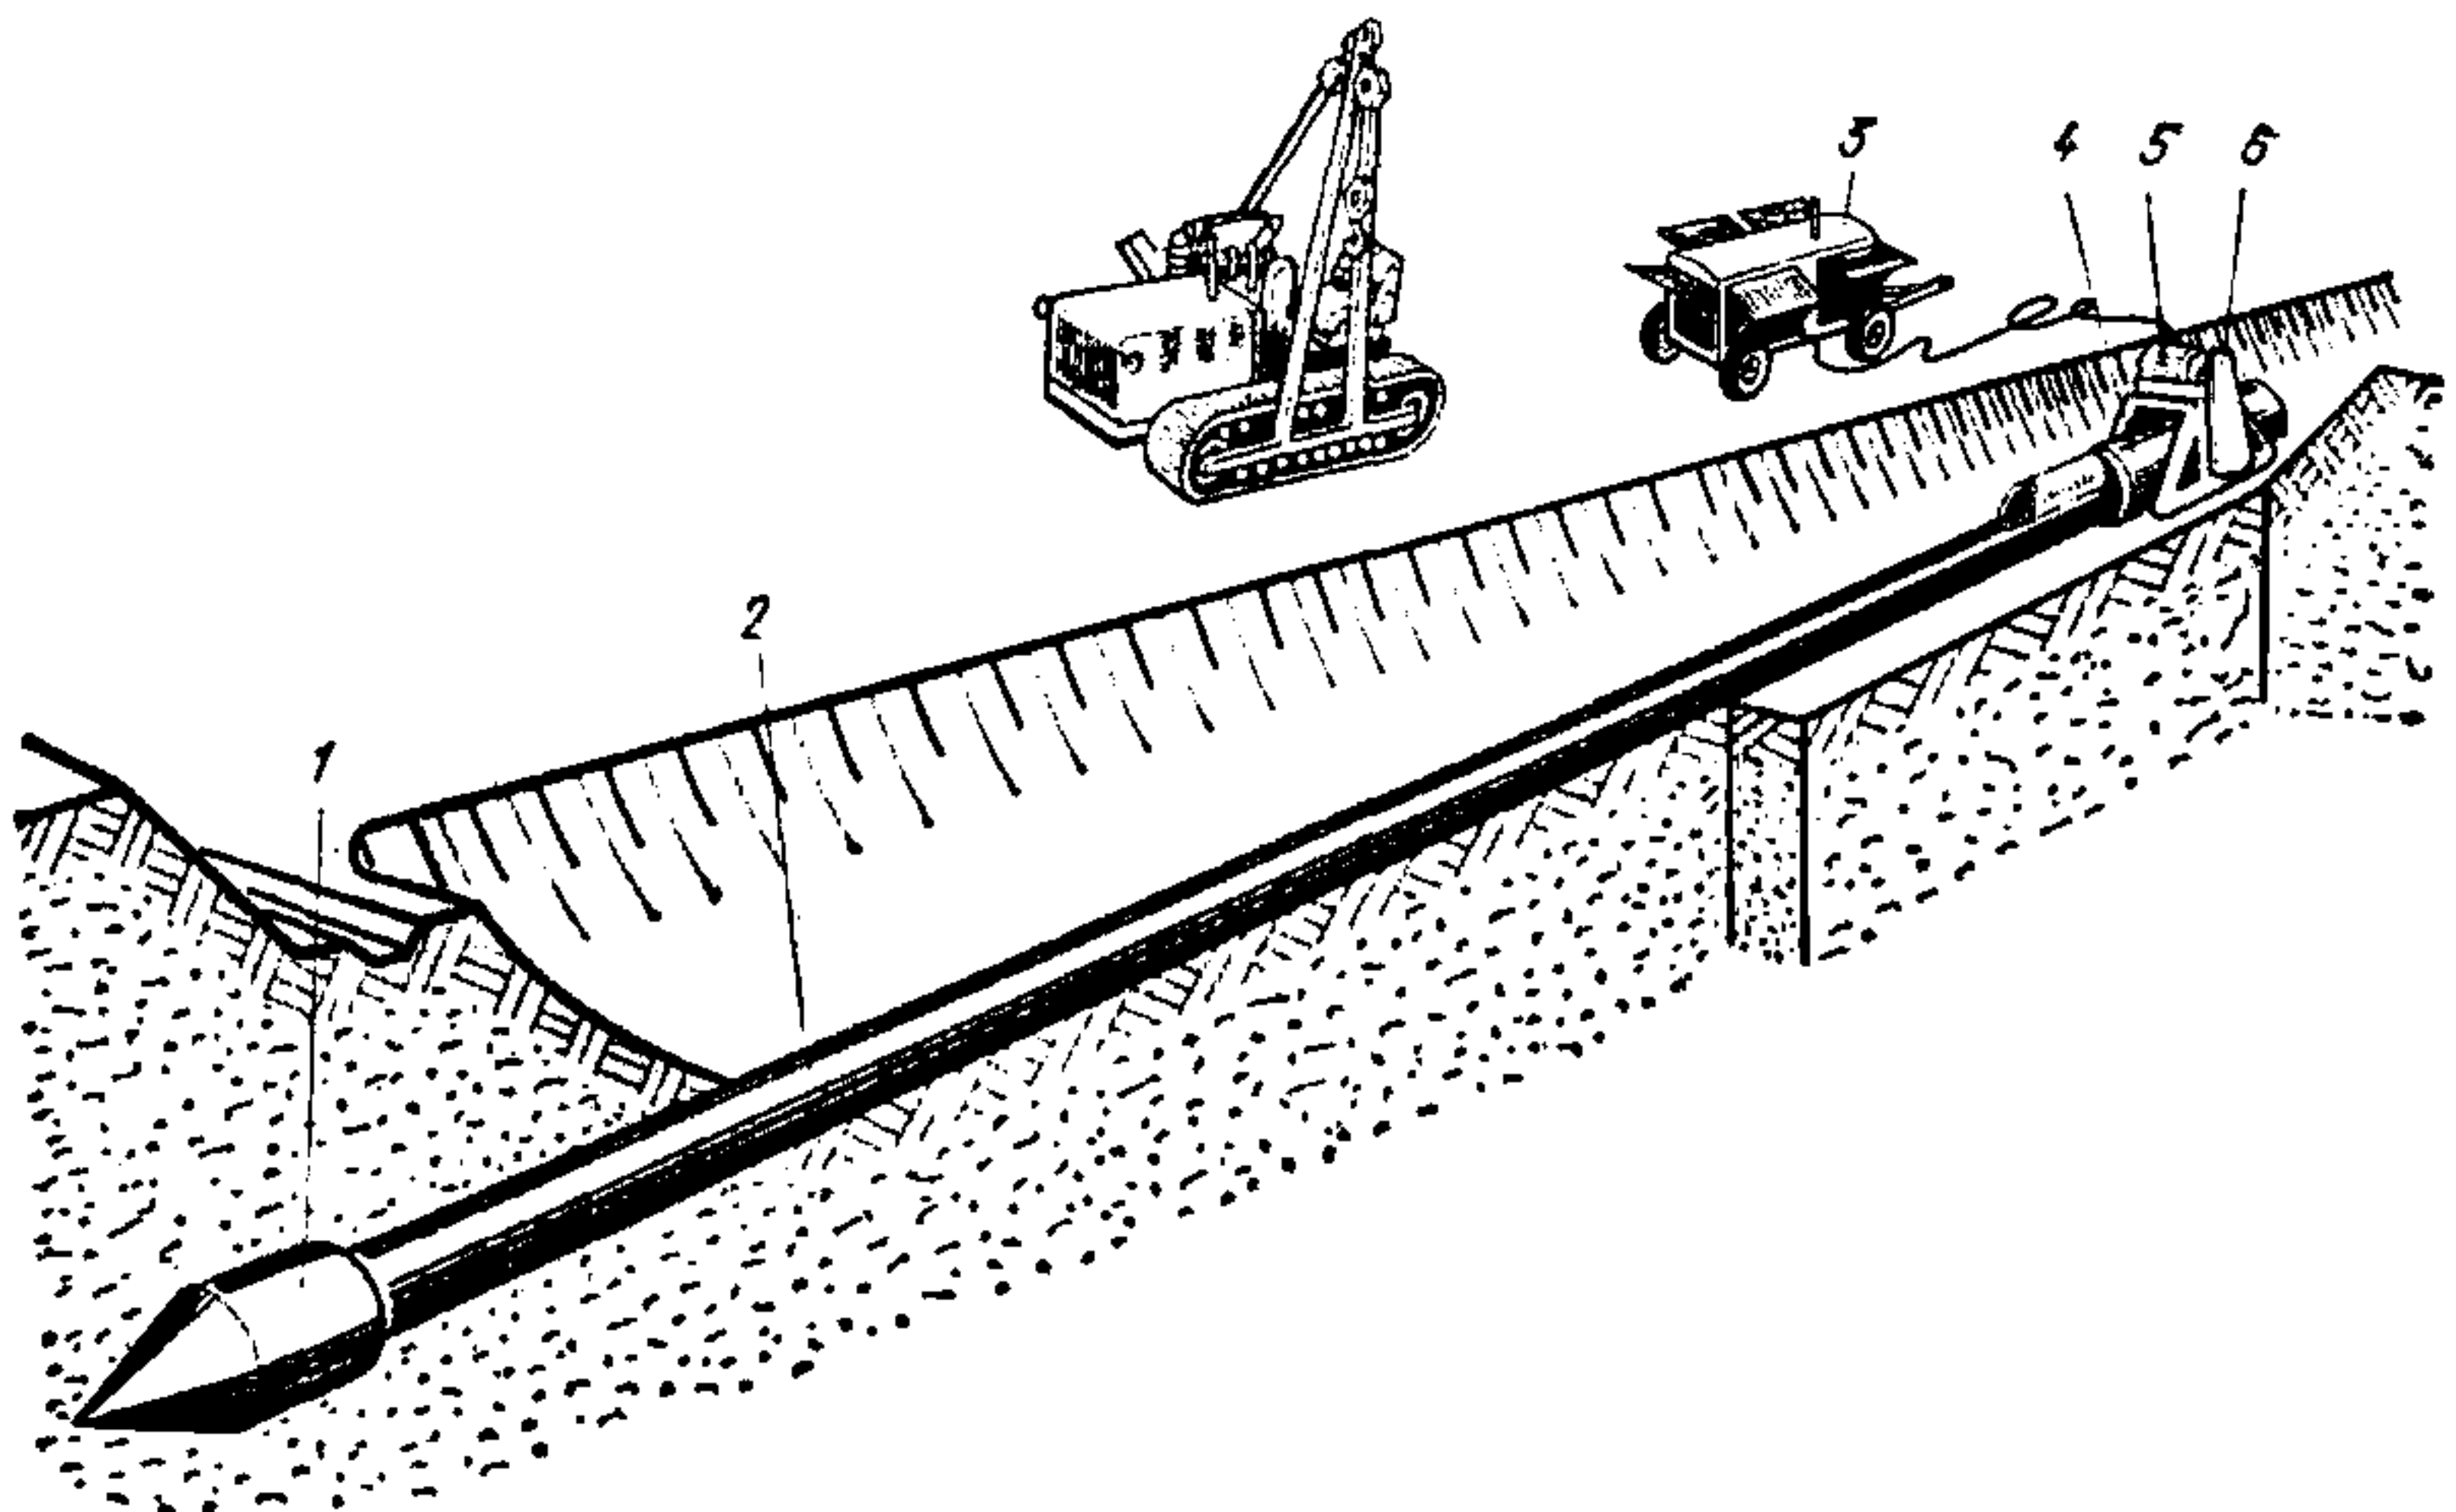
Схема бестраншейной прокладки трубопровода установкой УВГ-51
